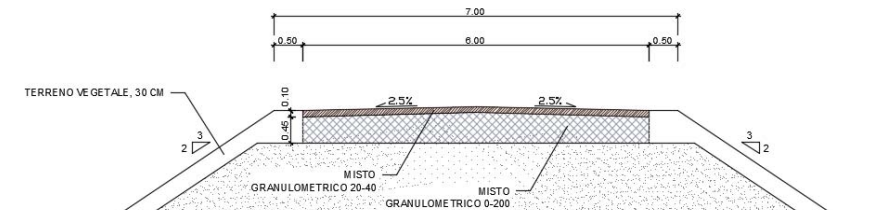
Sezione tipo in rilevato carreggiata 6 m.
